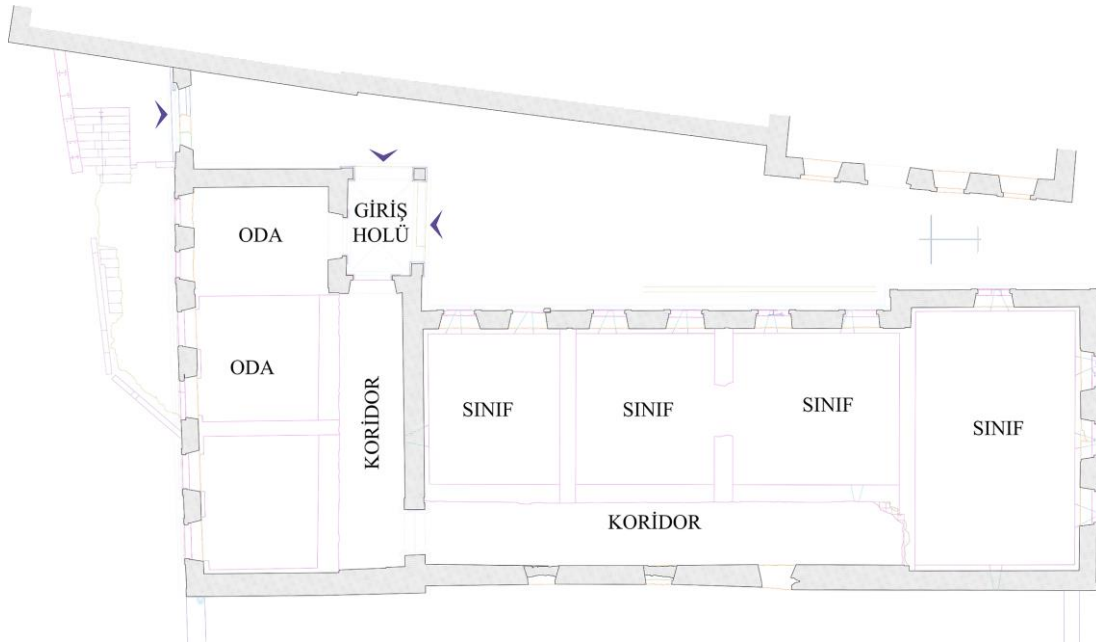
Gazi Paşa İlkokulu vaziyet planı (Dor Yapı Arşivi, 2007)
